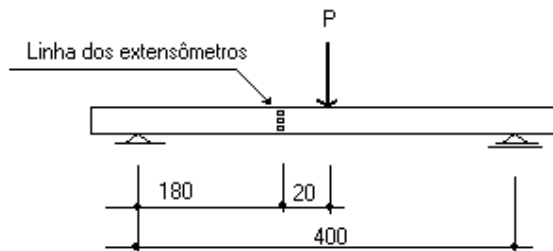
Aplicação de cargas e posição dos extensômetros. Unidade: cm
